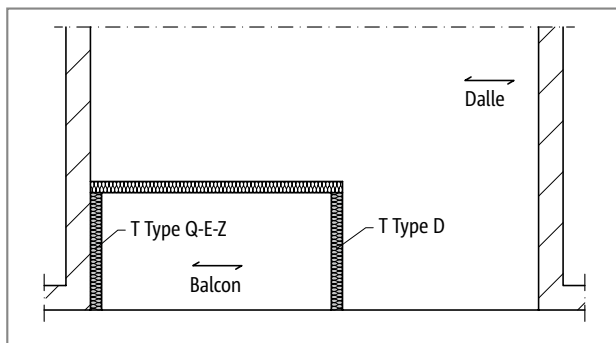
Schöck Isokorb® T Type D, Q-E-Z : Plancher à axe unique
